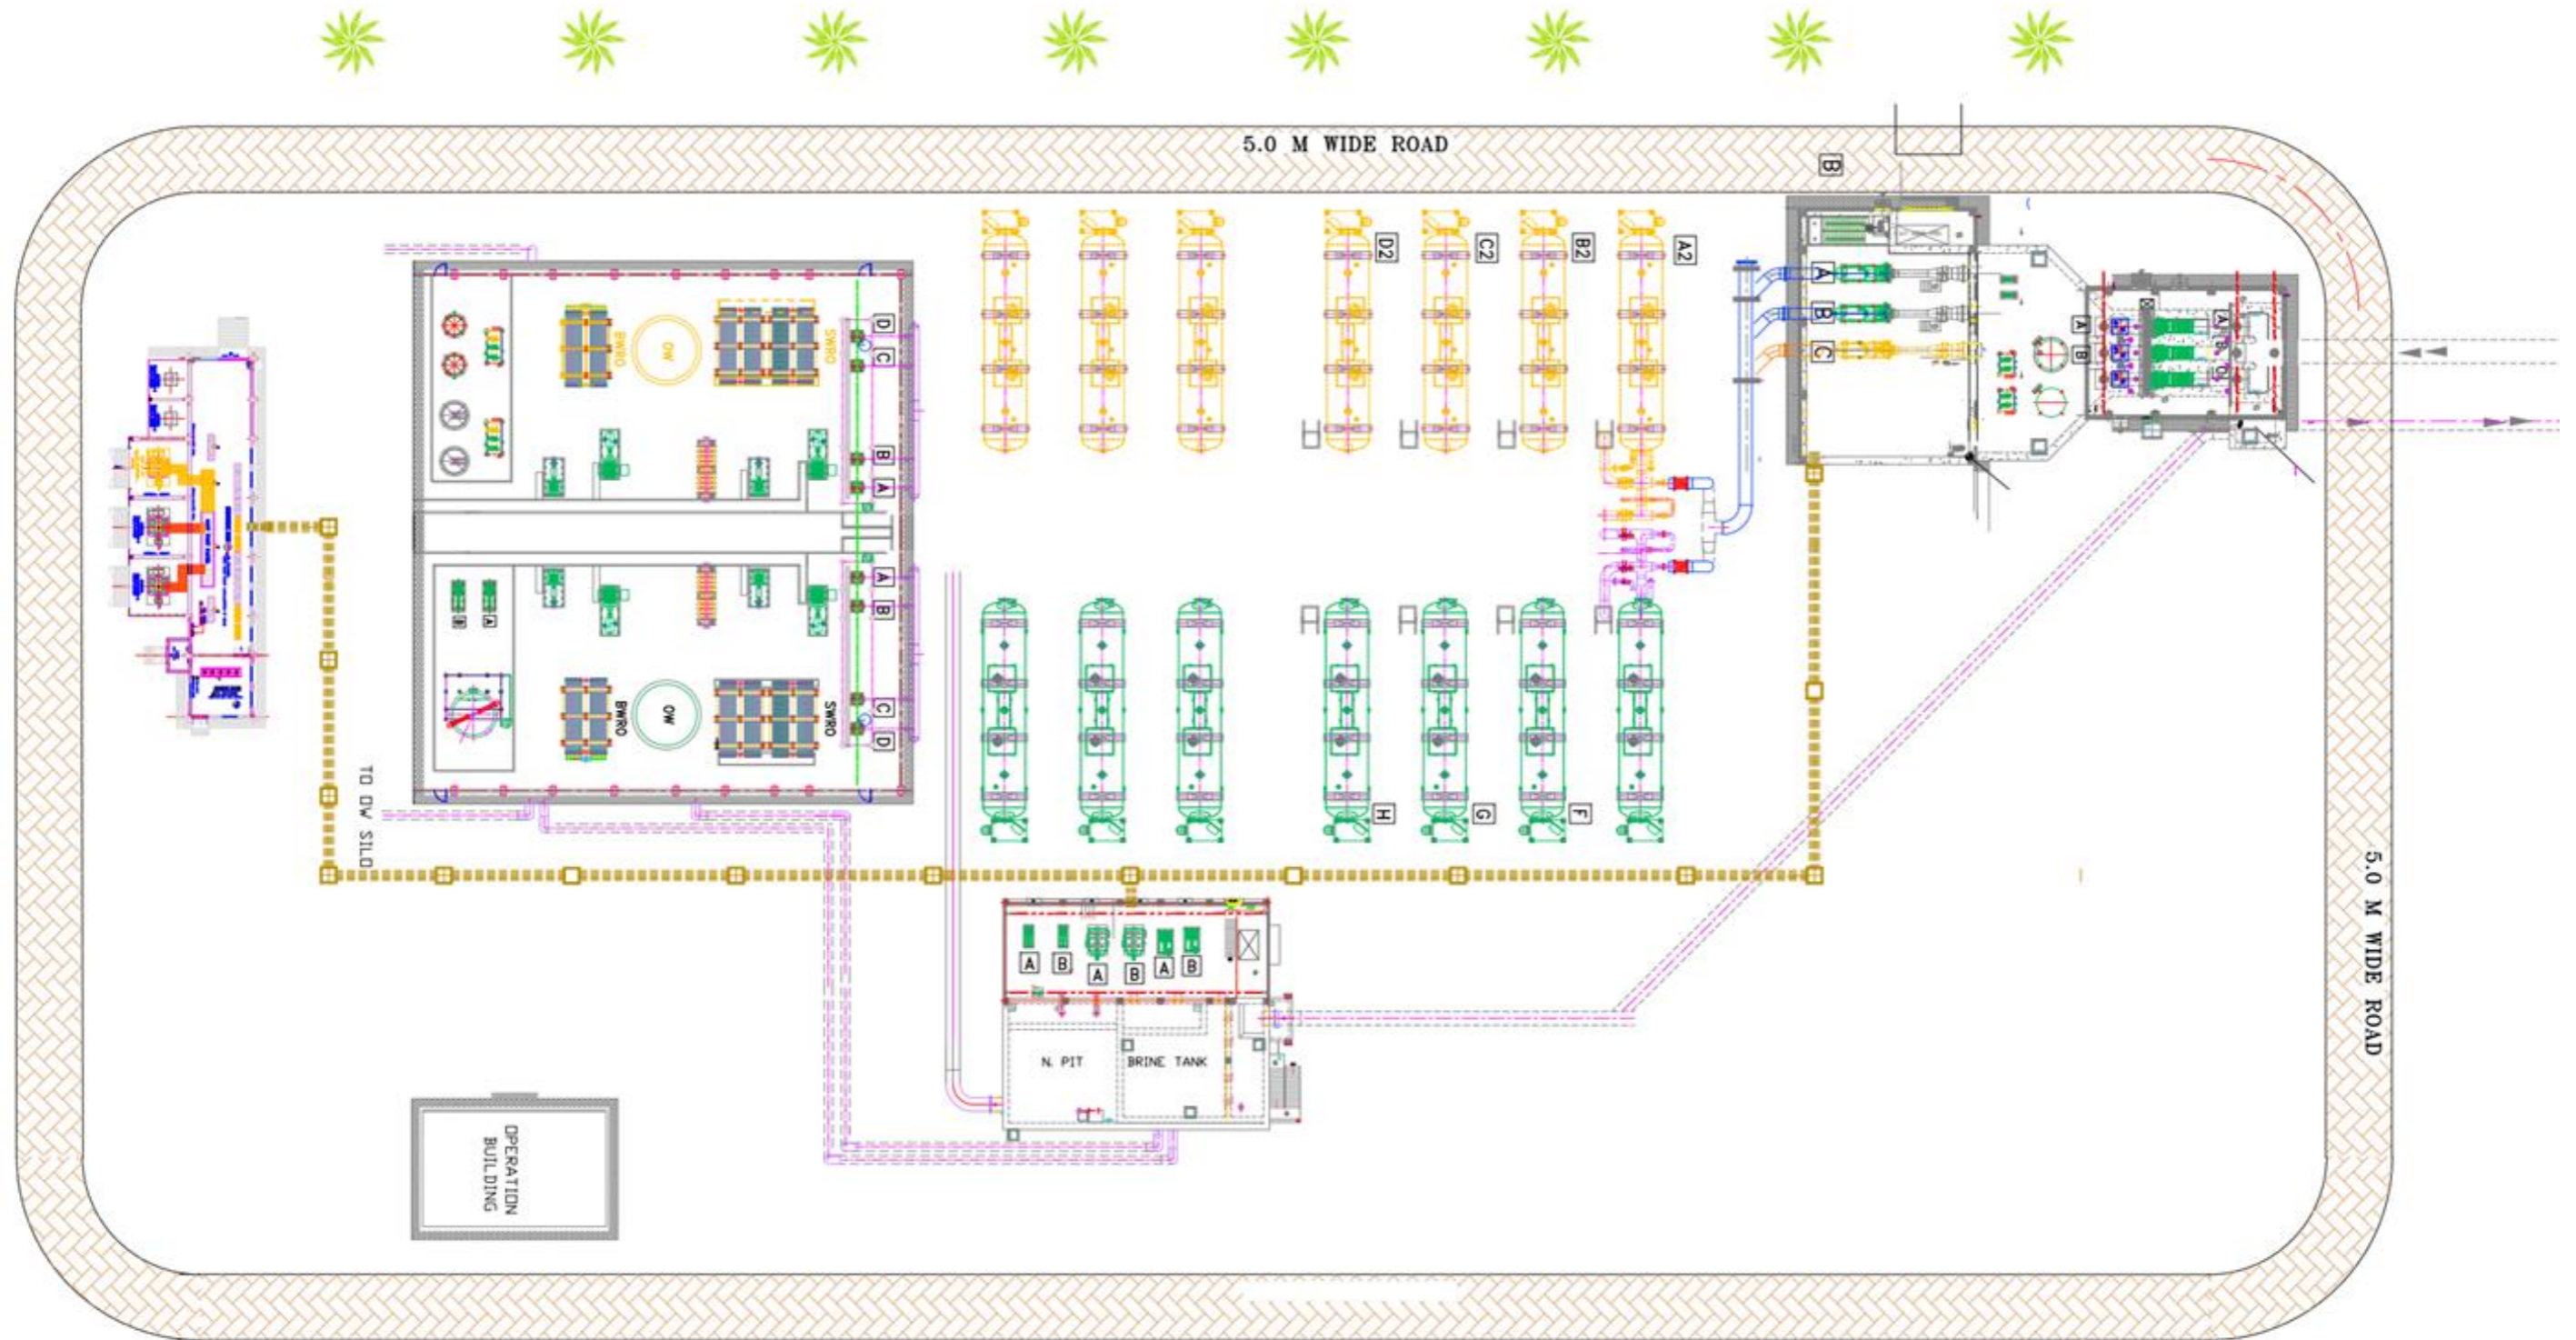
Plan d'implantation des ouvrages de la SDEM du projet HICHA JOY
